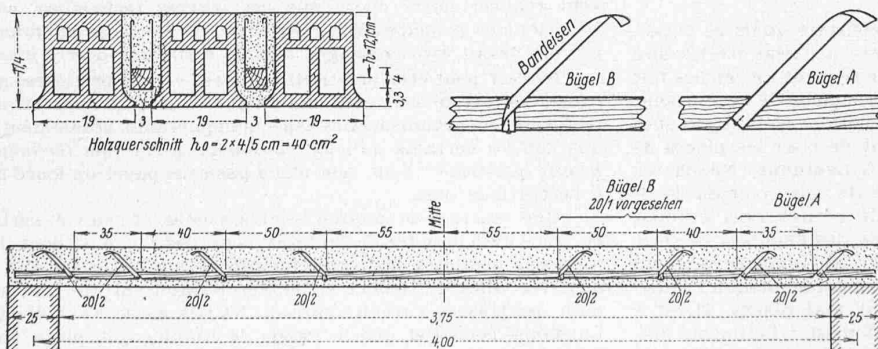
Holzbewehrte Versuchs-Betonbalken von Ing. E. Sperle, Ulm. Erste Ausführung
